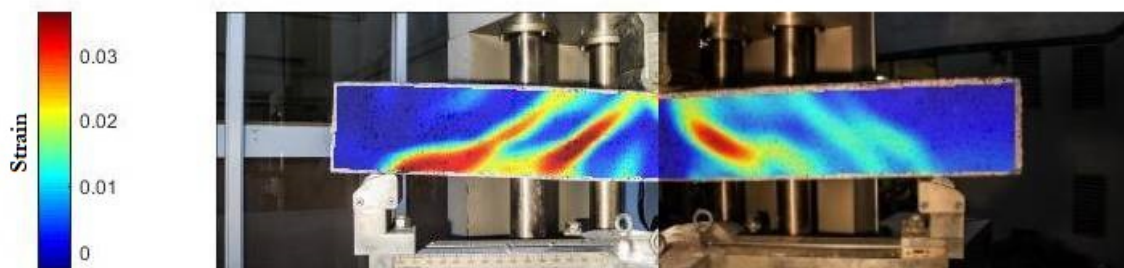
Perfil de deformaciones unitarias principales en la viga 1 para la fotografía 26.
